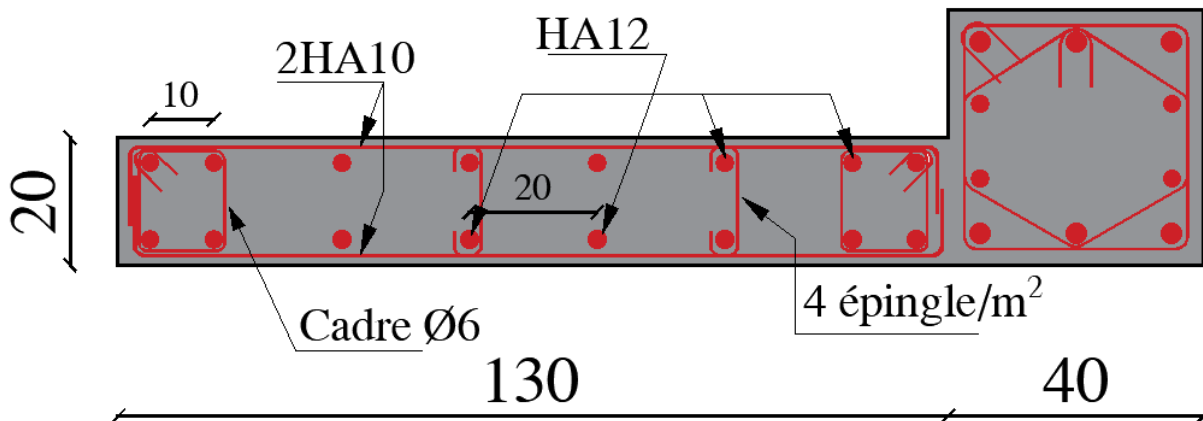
Schéma de ferrailage du Voile V_{x1} (niveau R.D.C)
